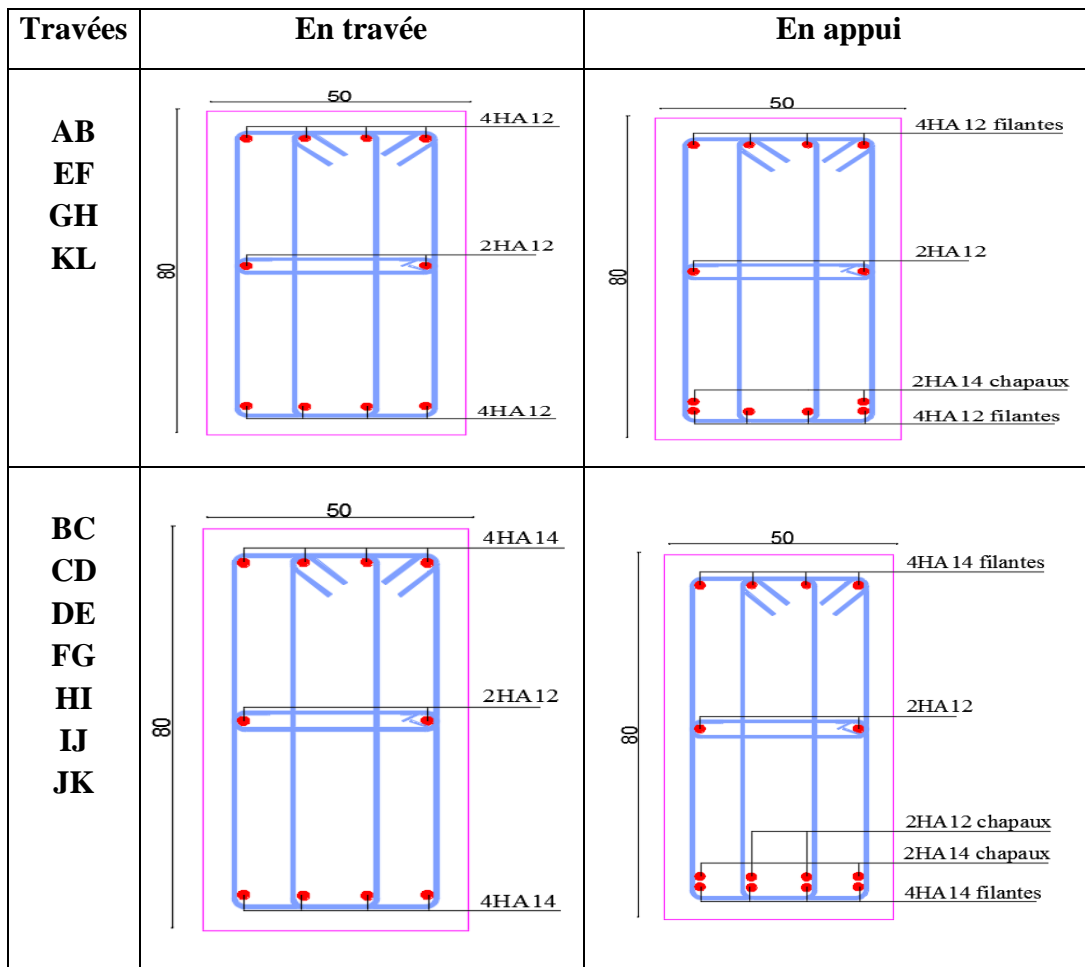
Schéma de ferrailage de la poutre de rigidité.
